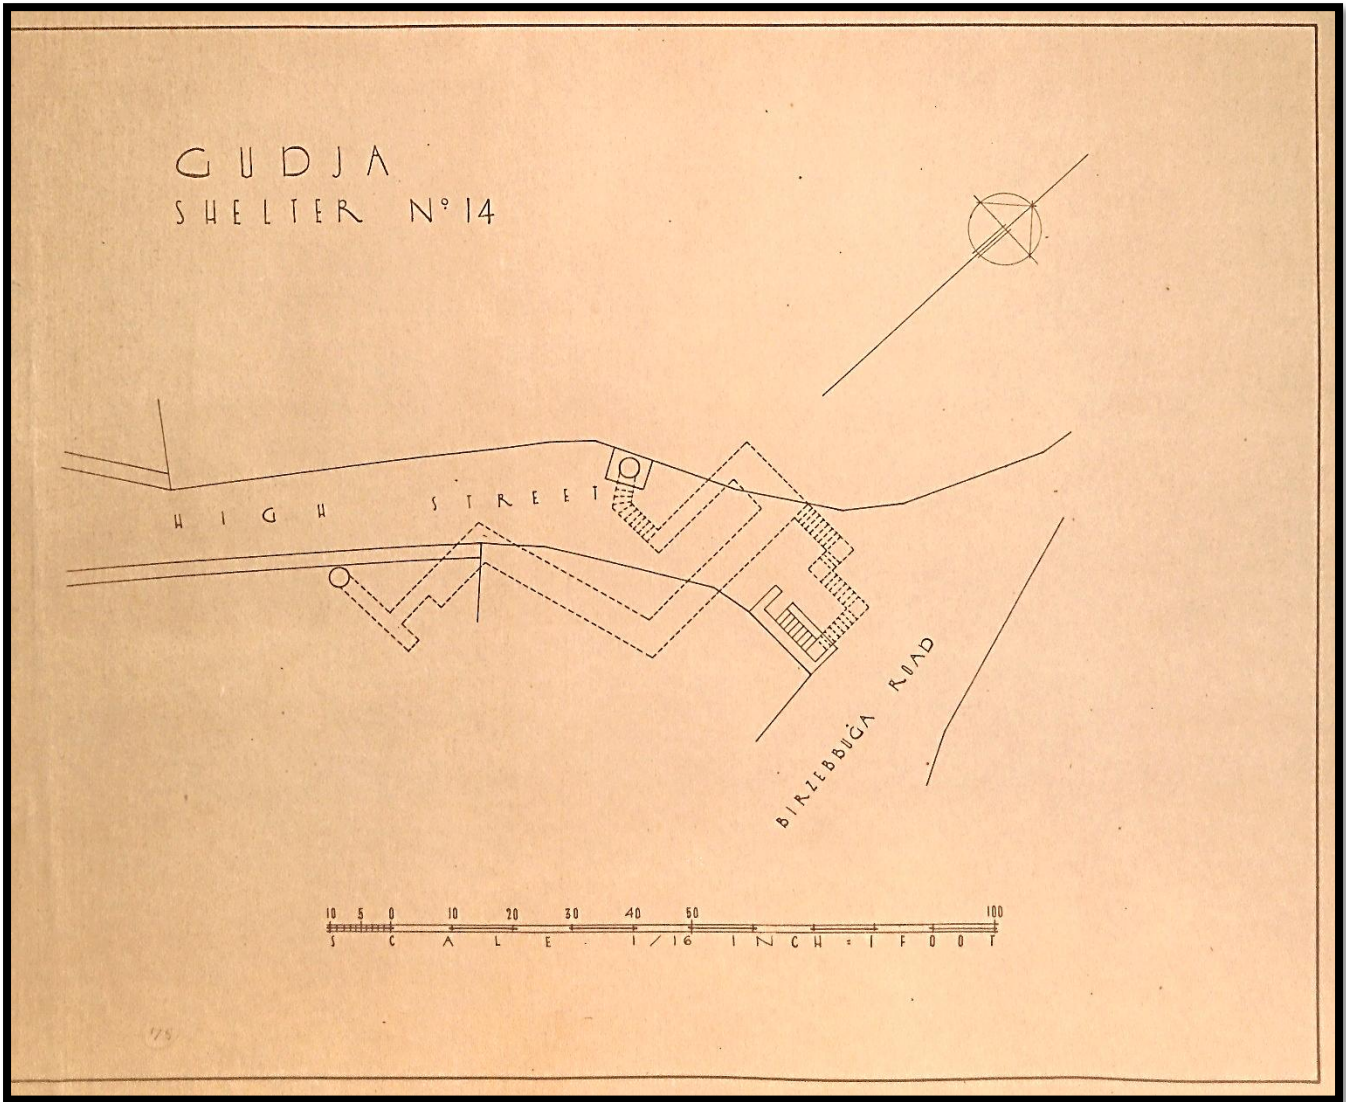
Planta do Abrigo nº14 "High Street - Birzebbuga Road."
